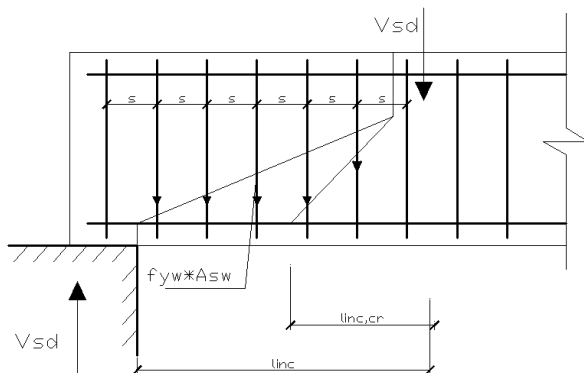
Схема усилий в сечении, наклонном к продольной оси железобетонного элемента, при расчете его на прочность на действие поперечной силы
